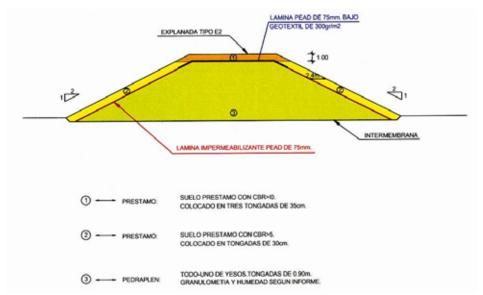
Sección tipo apoyo de los rellenos en zonas no encharcables
